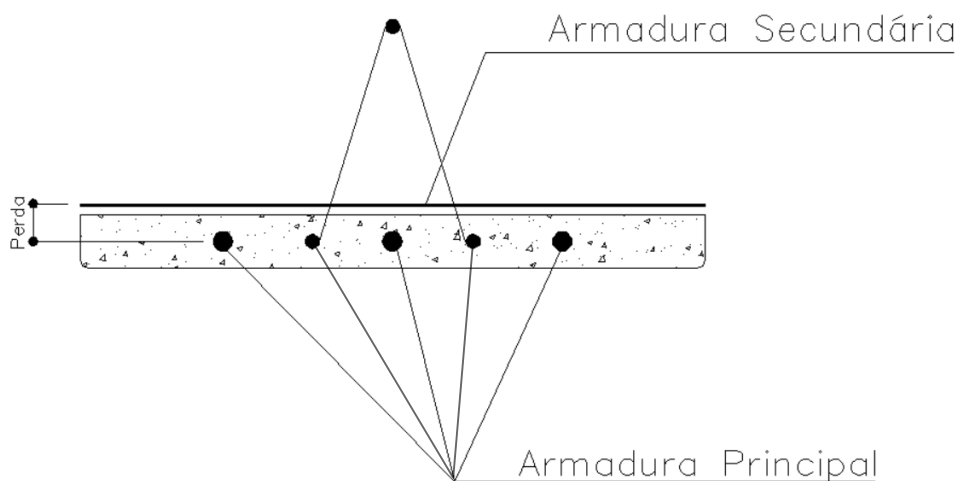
Exemplo de especificação de armadura para projeto de concreto armado.
